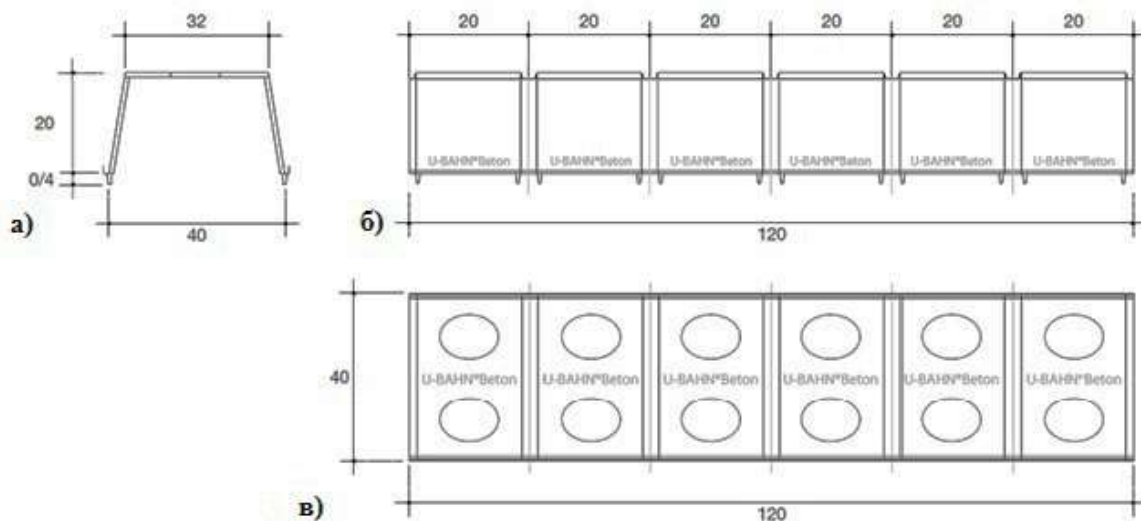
Вкладыш по технологии U-Bahn Beton: а) поперечное сечение; б) продольное сечение; в) план
